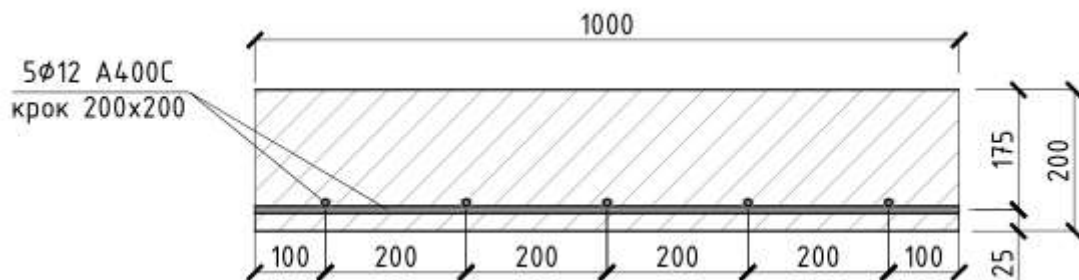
Нижня розкладка арматури по всій площі плити.
